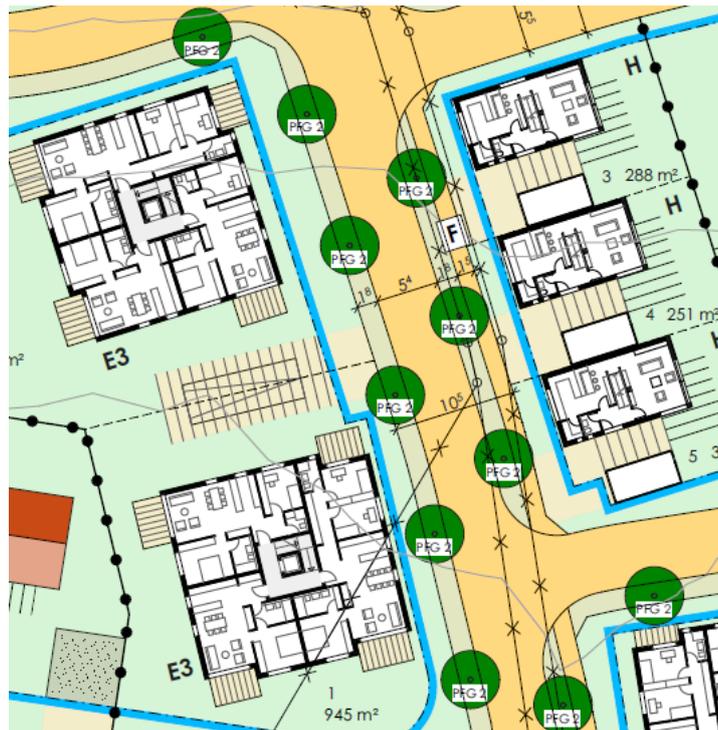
Grundriss-Studie Mehrfamilien-Wohnhäuser und Hausgruppen
